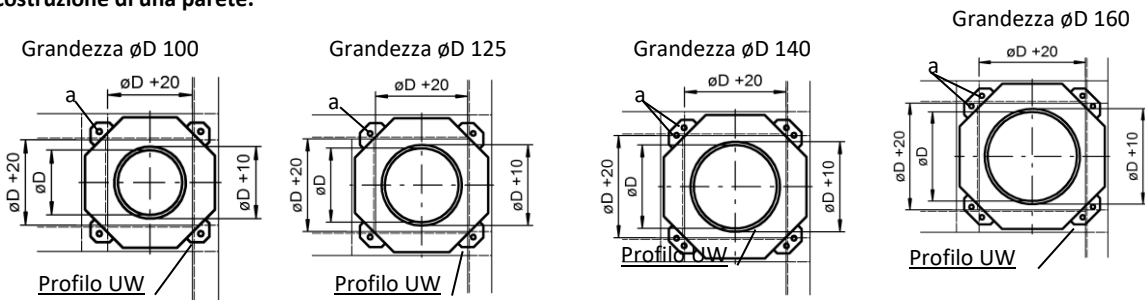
montaggio a secco con telaio AR su una parete divisoria leggera (F30/F60)
